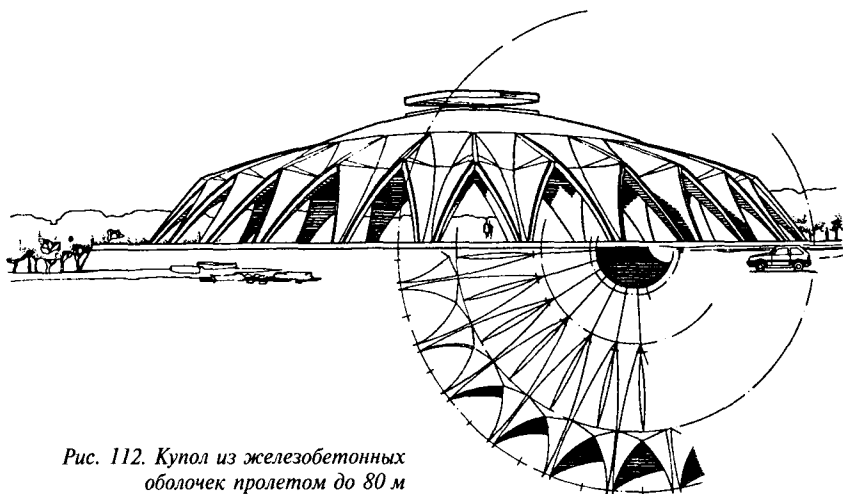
Купол из железобетонных оболочек пролетом до 80 м
